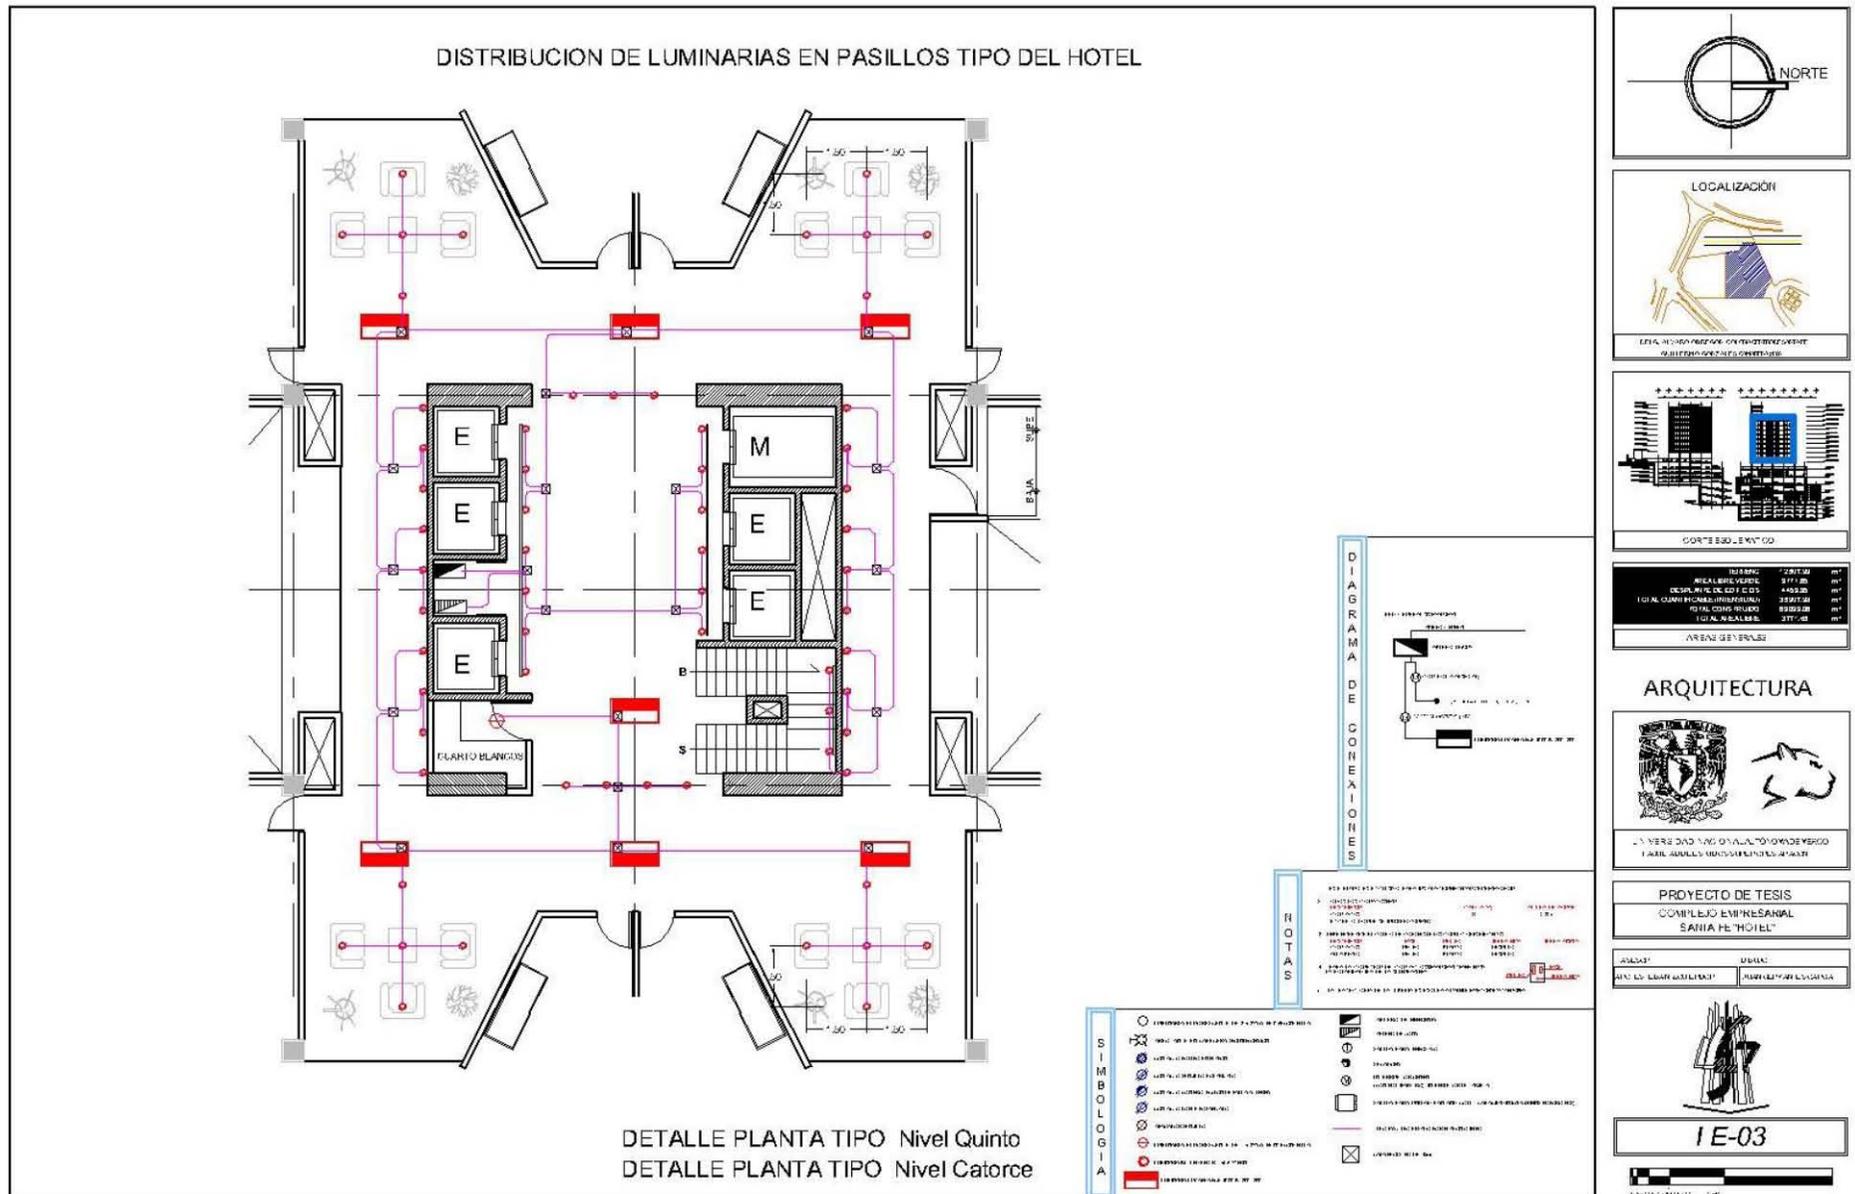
Plano IE-02; Plano distribución de luminarias en pasillo tipo de hotel. Edición propia.
